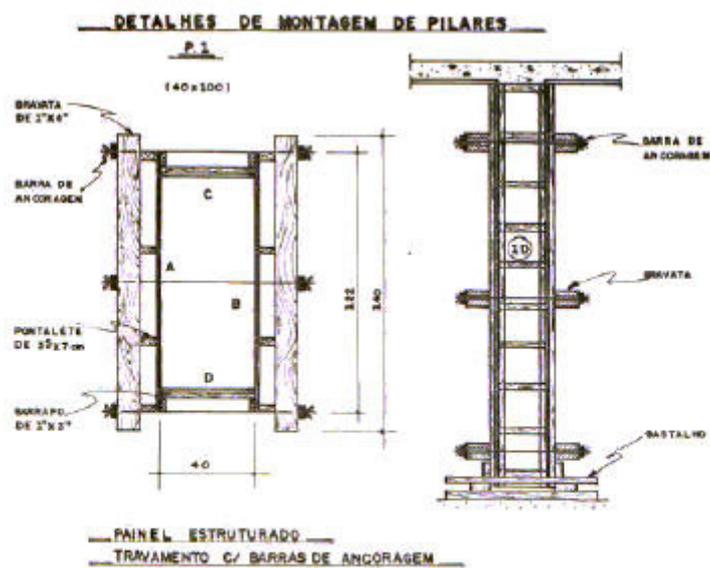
Reforço das travessas por meio de barras de ancoragem.
